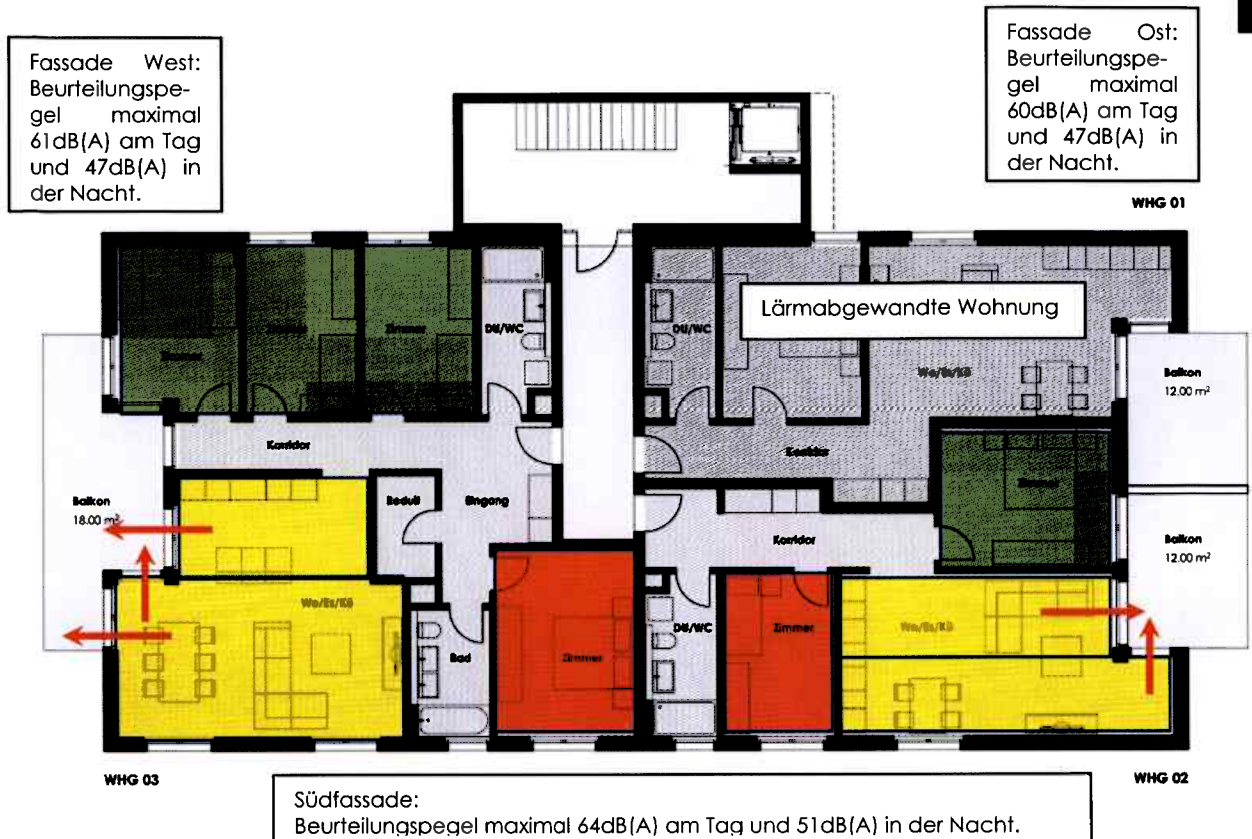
Beispiel Grundrissplan Vollgeschoss; Grün: IGW an allen Fenstern eingehalten Gelb: IGW am Lüftungsfenster eingehalten. Rot: IGW an allen Fenstern überschritten. Roter Pfeil: massgebliches Lüftungsfenster
